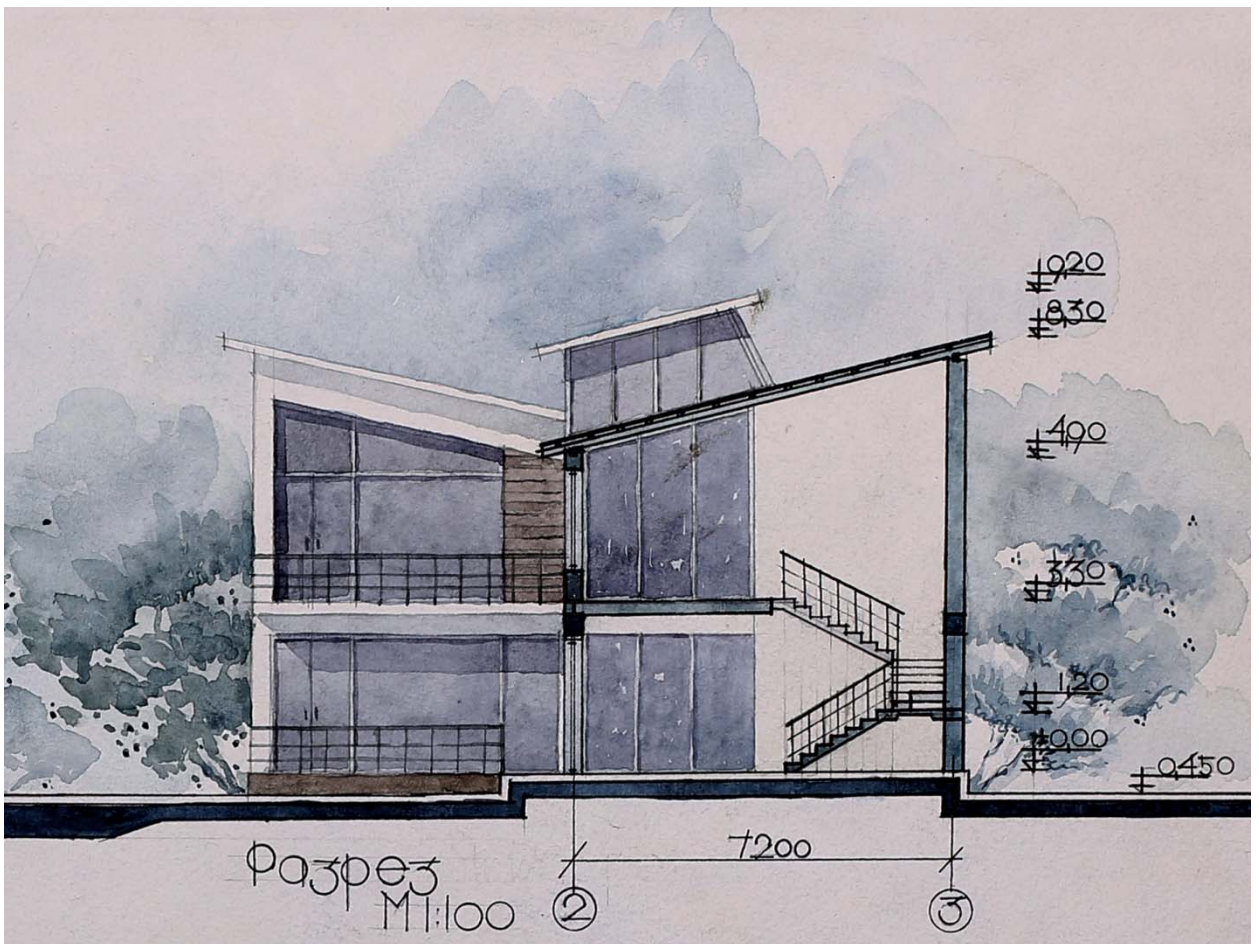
Проект 2-х этажного жилого дома.Разрез а-а. М 1:100.
